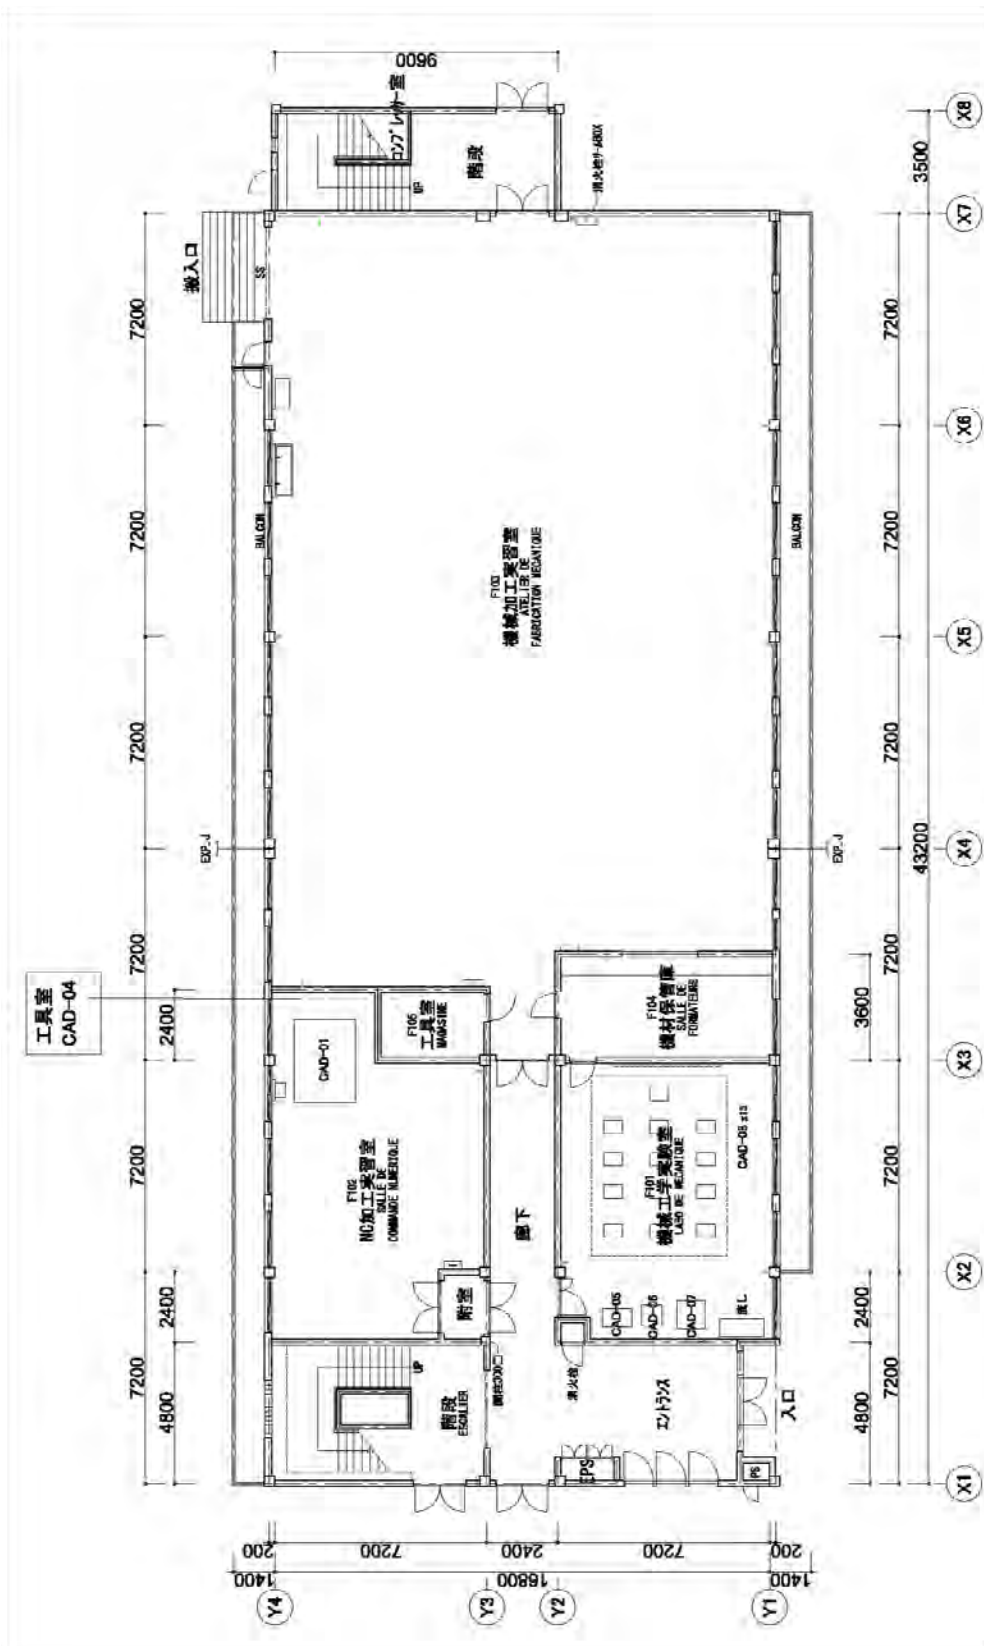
平面図・機材配置図 (F 棟 1 階 電気機械科 CAD/CAM コース)
